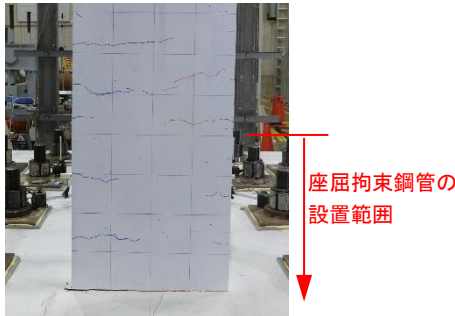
曲げひび割れの位置 (3-1試験体)
